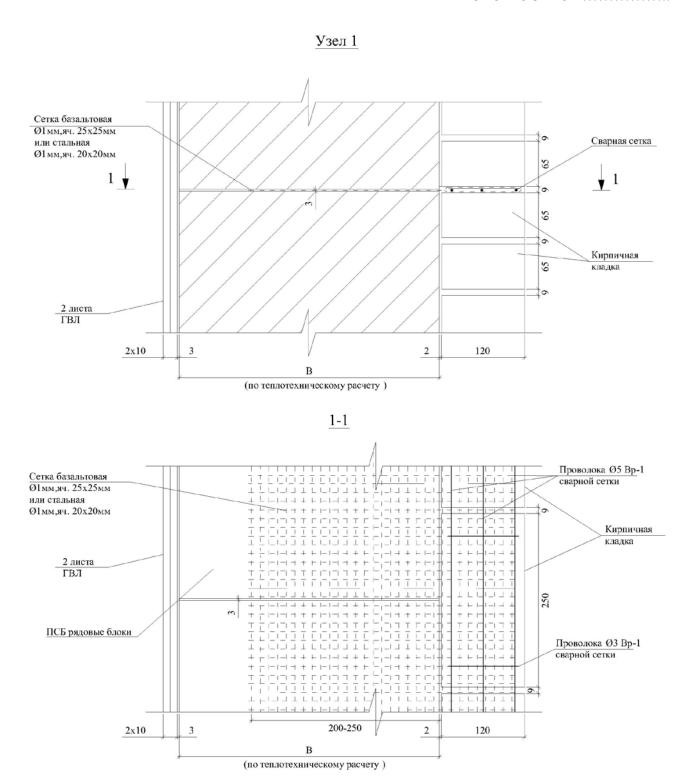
Крепление кирпичного облицовочного слоя к стене из ПСБ блоков с использованием штукатурной сетки
